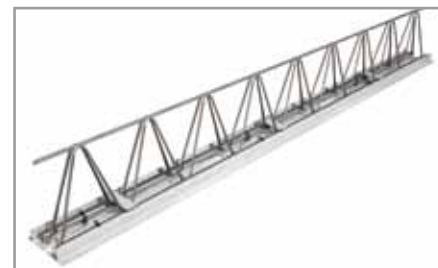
Балка перекрытия МАРКО-УНИВЕРСАЛ
